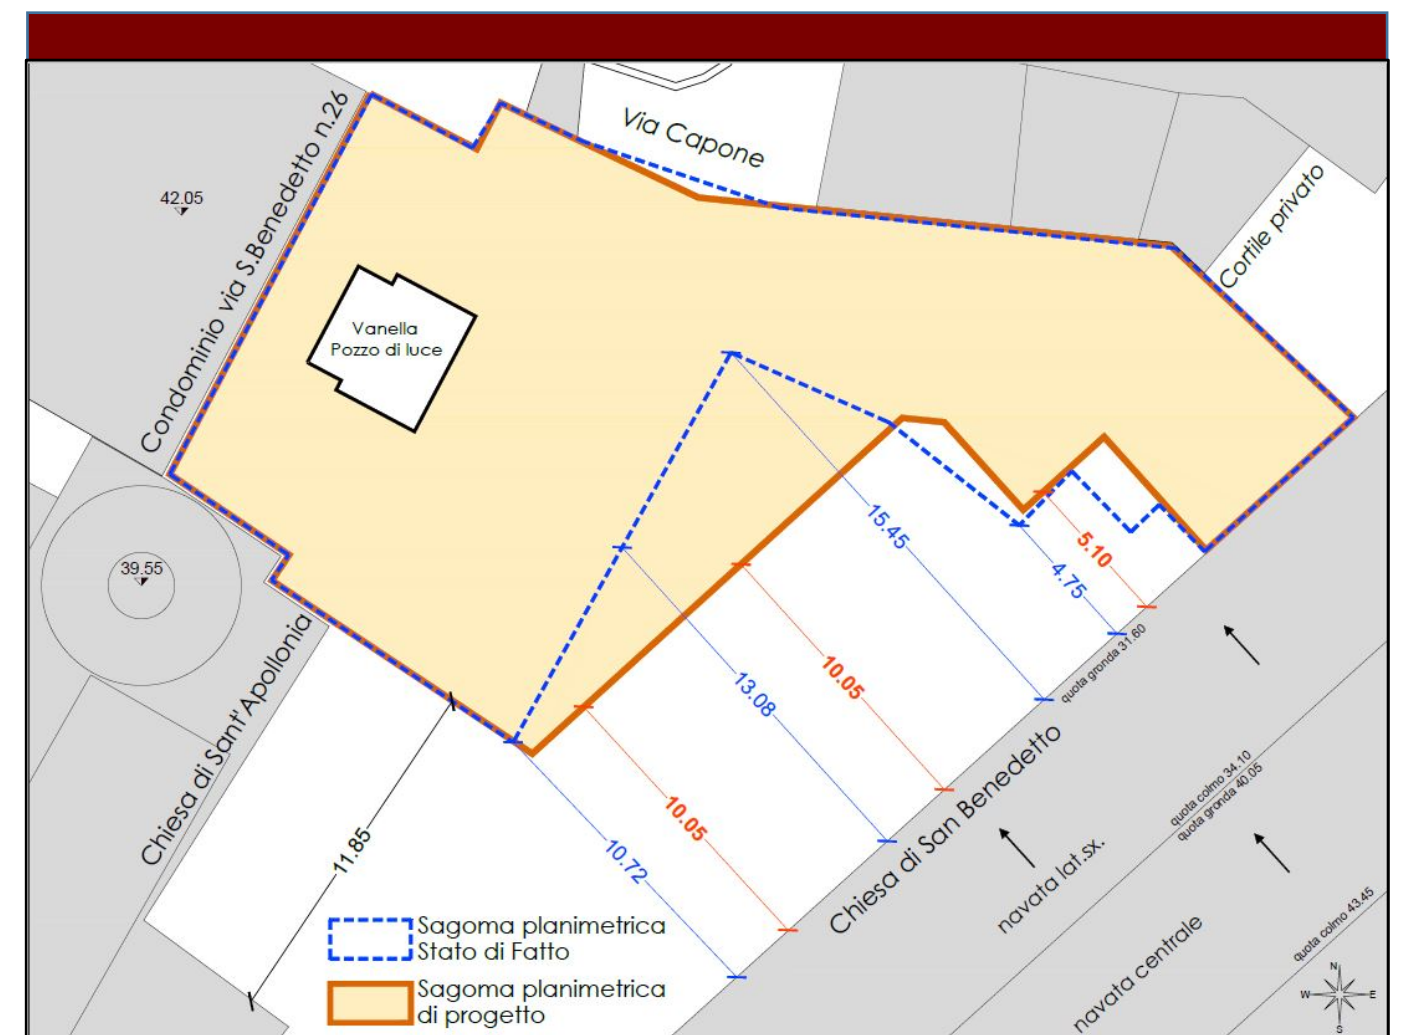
Sovrapposizione della sagoma dello stato di fatto con quella di progetto
